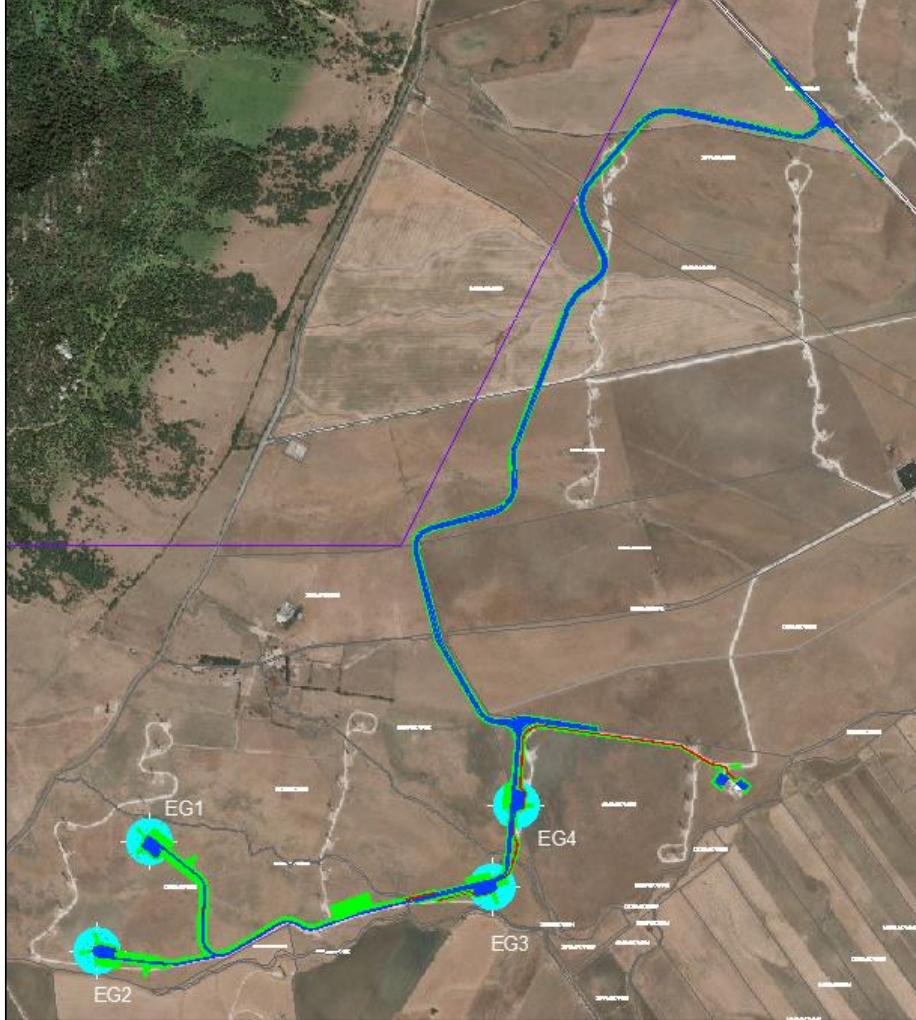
Plano RBDA del proyecto parque eólico El Gallego.
